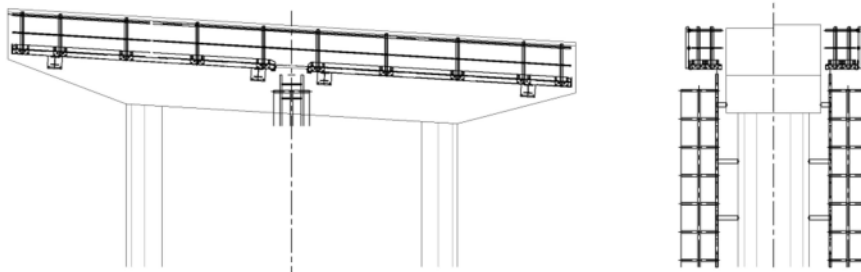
Passerelle d'inspection (vue en coupe et vue de côté)
